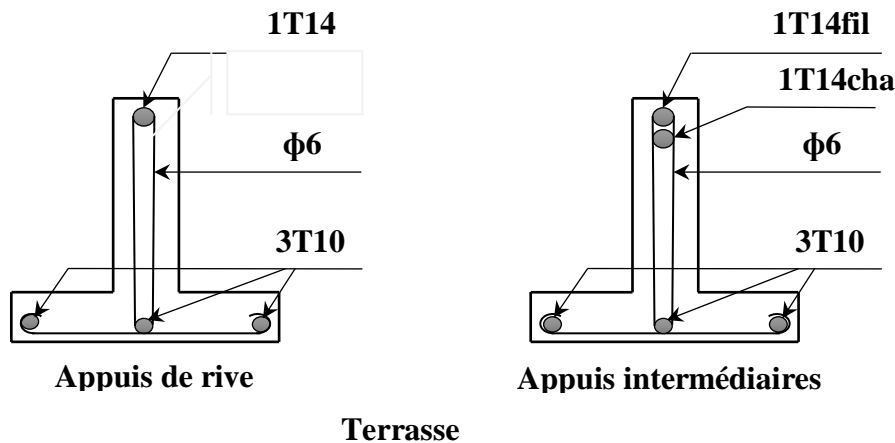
Dessin de ferrailage des poutrelles (terrasse).
